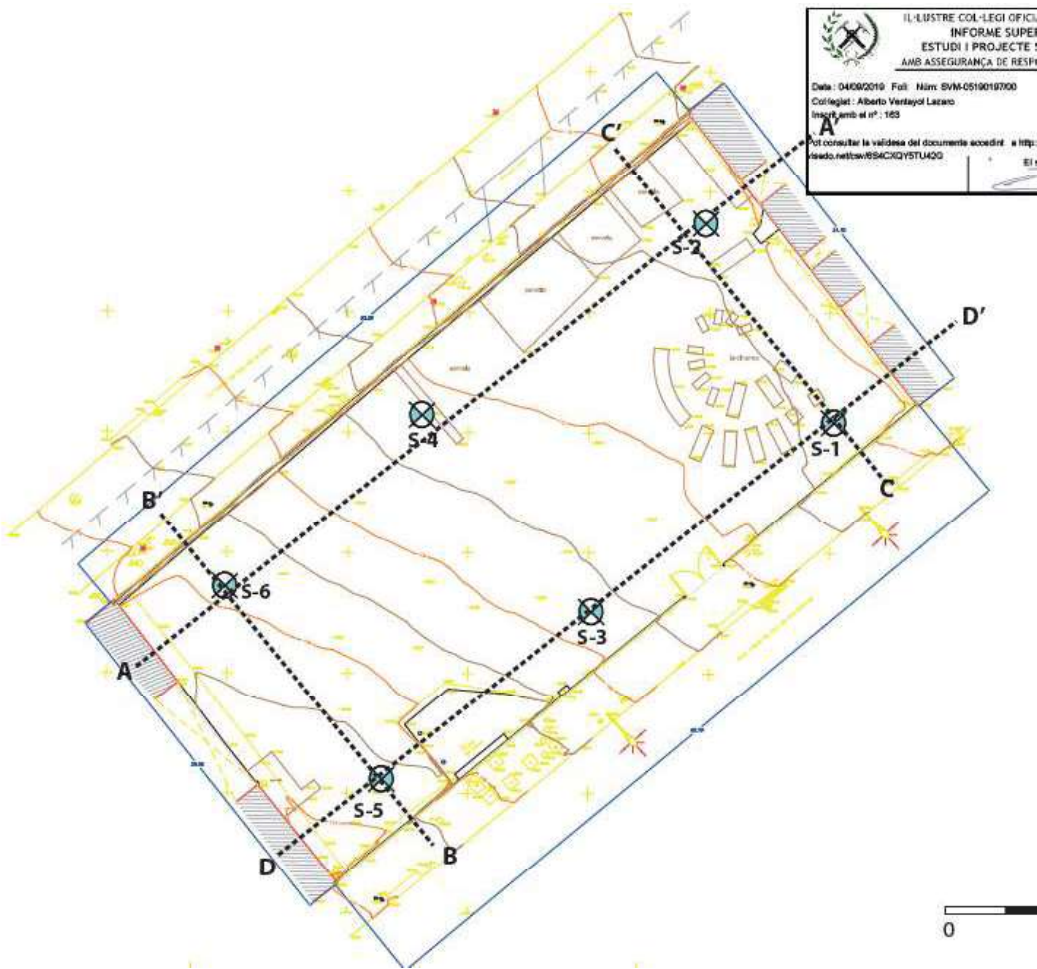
Planta de la parcela con ubicación de sondeos (Fuente: Informe Geotécnico nº2123P6321)
